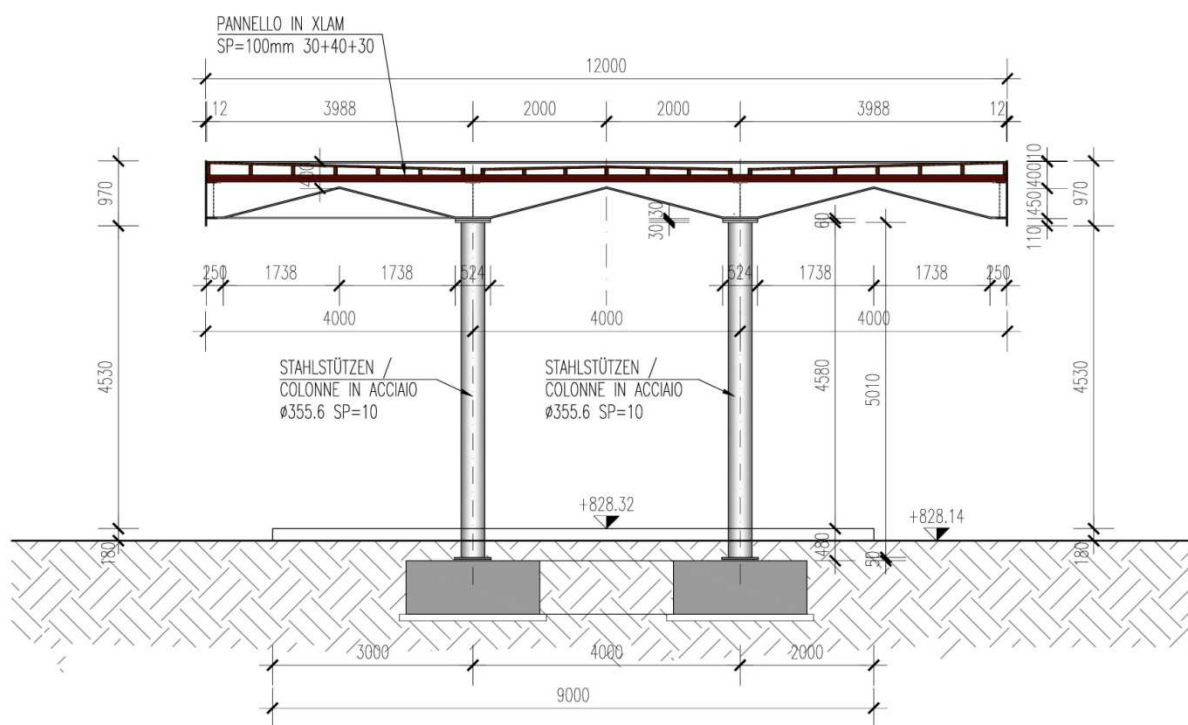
Sezione tipo della copertura dell'autostazione
